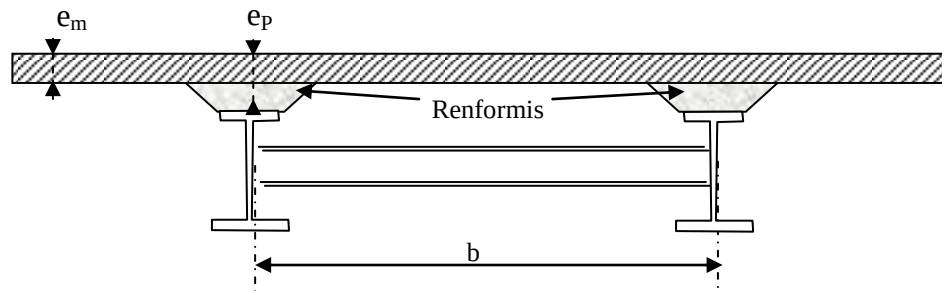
Coupe transversale d'ouvrage a entretoise.
